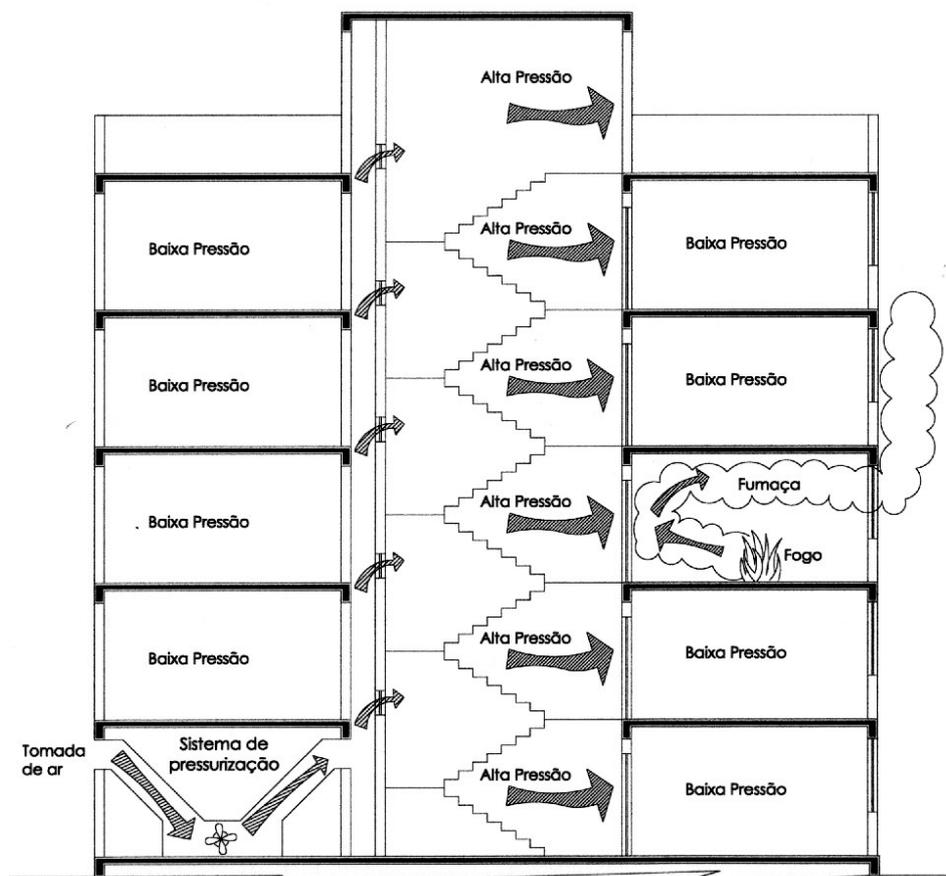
Sistema de pressurização, instalado no pavimento térreo, joga ar para dentro da caixa da escada através de duto de ventilação.
